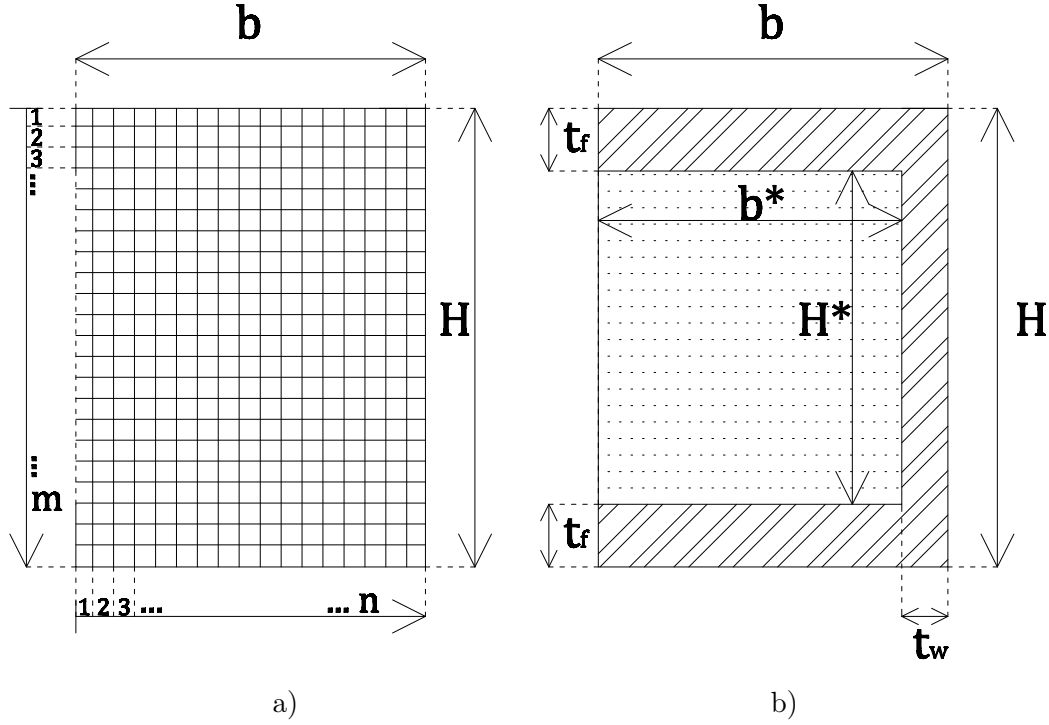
a) Malha de discretização da secção; b) secção em C e respectivas dimensões.
